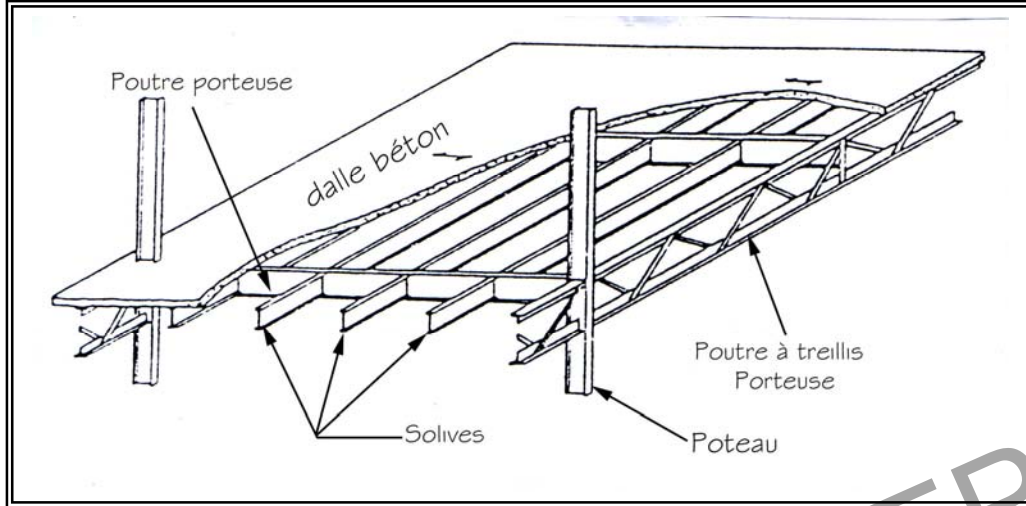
Constitution d'un plancher mixte acier dalle en béton.
